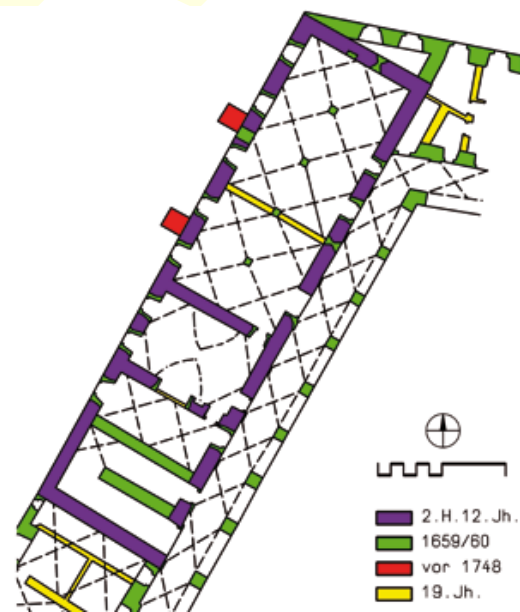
Heiligenkreuz, Stift. Kaisertrakt Nord, Baulalterplan des Erdgeschoßes.
